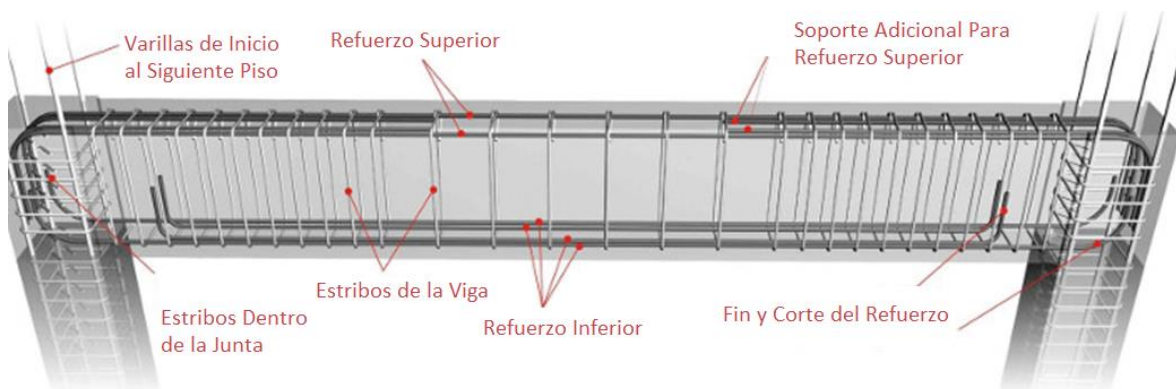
Construcción y Colocación del refuerzo a corte y flexión de una viga armada
